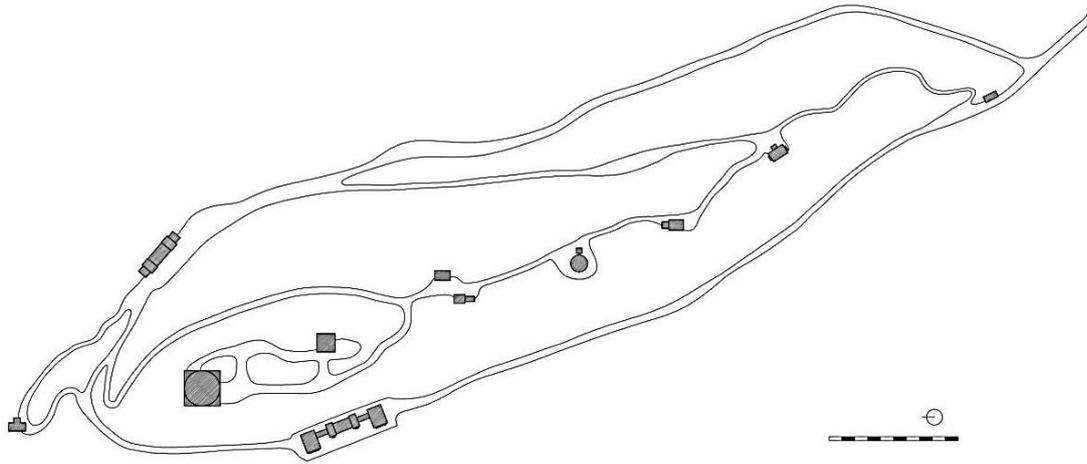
Observatorio de Niza. Planta de conjunto.
